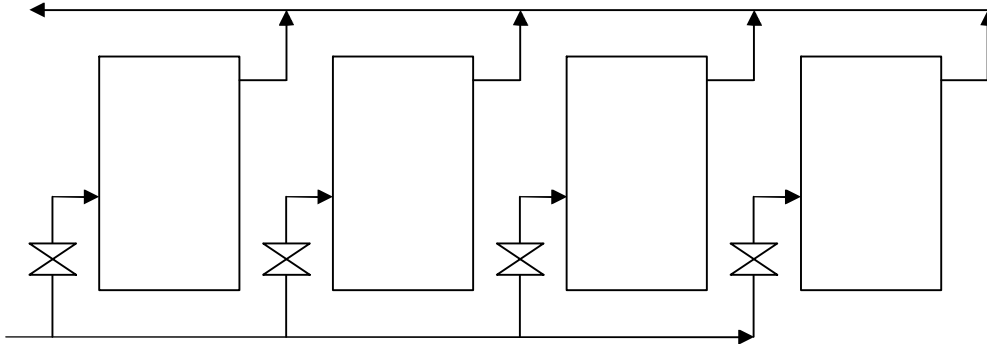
INTERCONEXIÓN EN PARALELO CON VÁLVULAS DE EQUILIBRADO Y TUBERÍA EXTERIOR.
